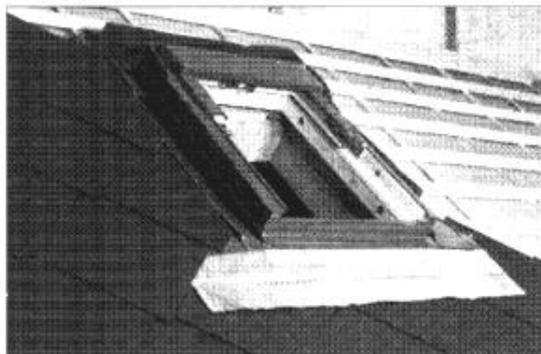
Pose d'une fenêtre de toiture sur des ardoises losanges
